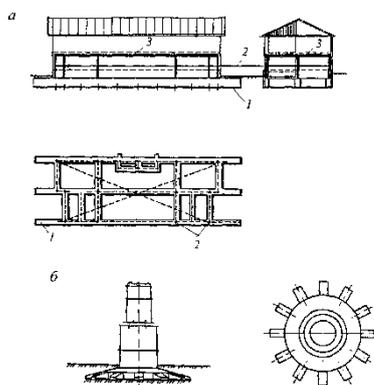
Противокарстовые фундаменты: а - противокарстовое конструктивное усиление жилого дома; б - фундамент дымовой трубы с консольными выступами; 1 - ленточный фундамент; 2 - армированные стойки; 3 - армированная горизонтальная рама на уровне первого этажа
